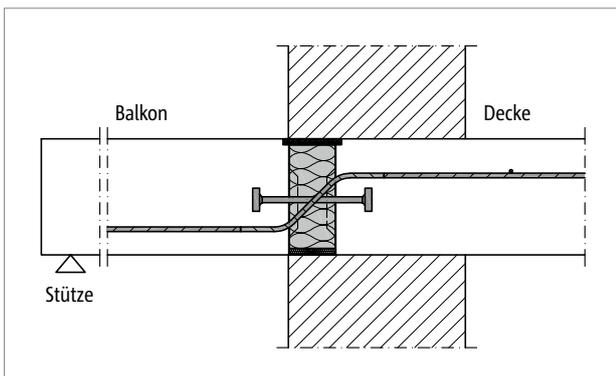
Schöck Isokorb® T Typ Q-P: Anschluss gestützter Balkon bei einschaligem, wärmedämmendem Mauerwerk
